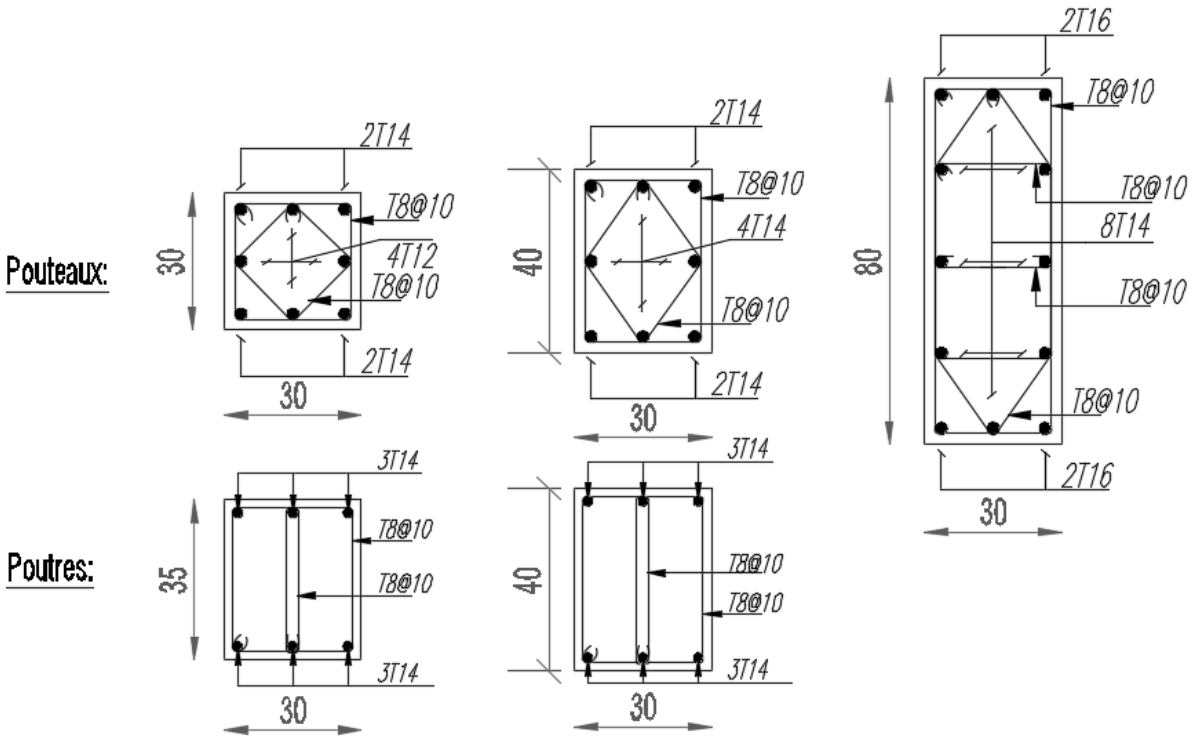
Ferrailage des sections transversales des poteaux et poutres
